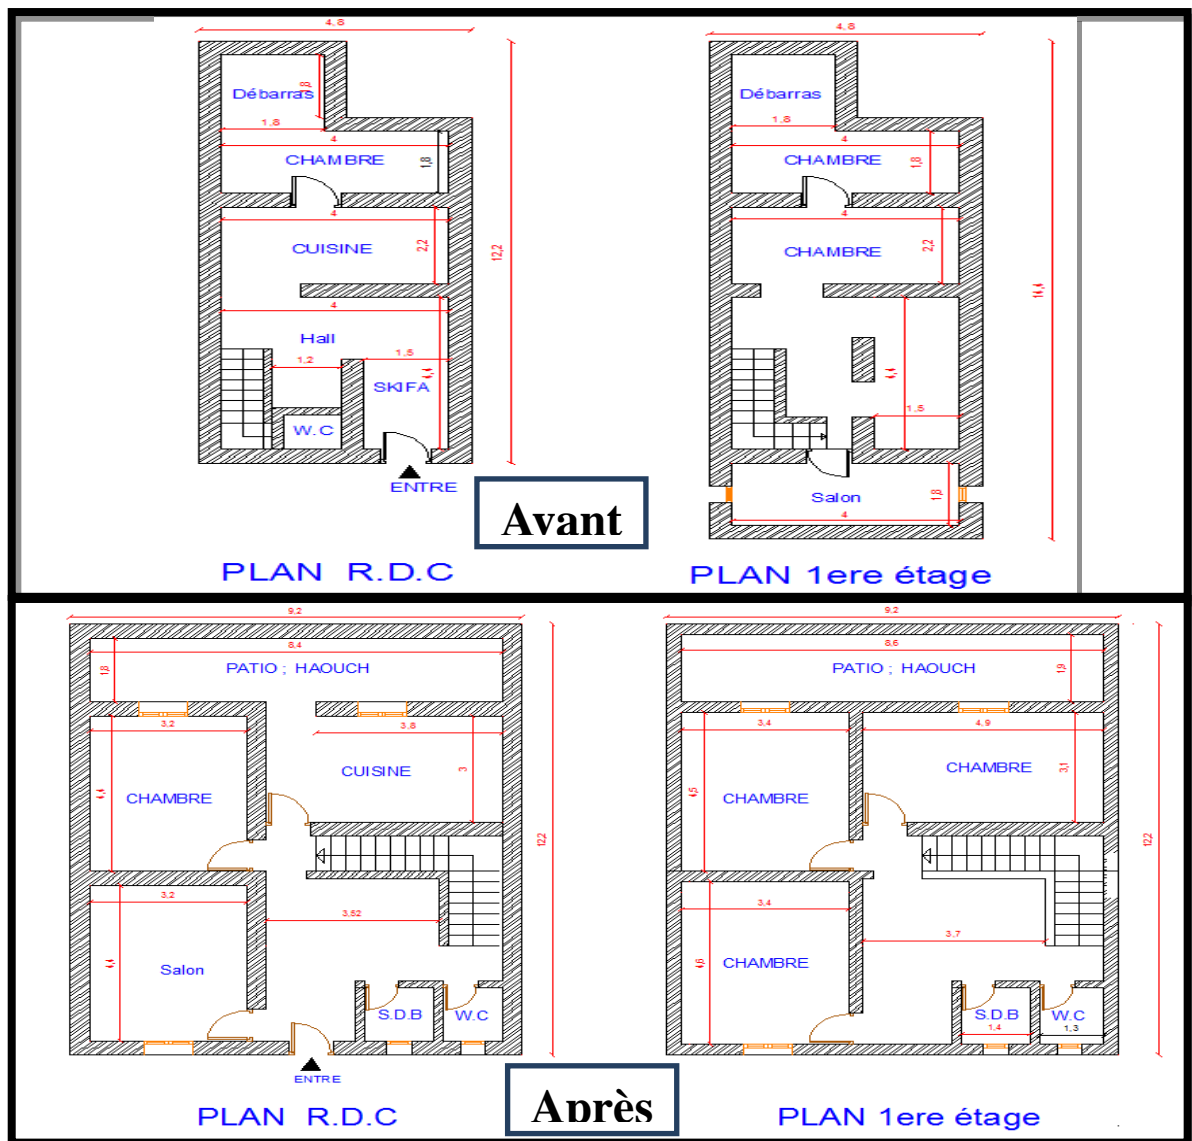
Plans de modification de maison (3). (Source : par l'auteur)
